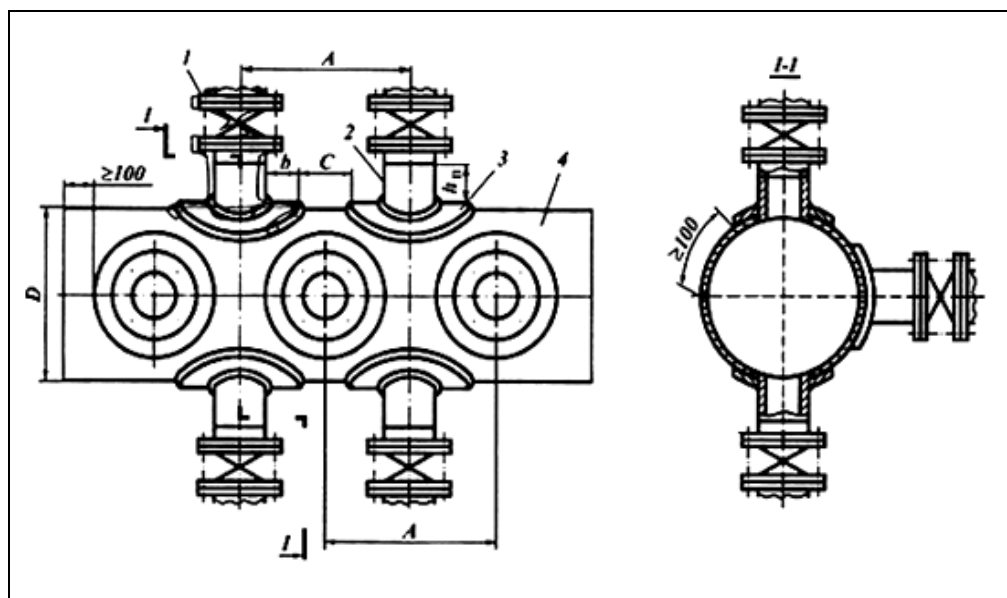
Схема расстановки вантузов при врезке для откачки нефти: 1 - задвижка; 2 - патрубок; 3 - усиливающая накладка (воротник); 4 - ремонтируемый трубопровод; А - расстояние между вантузами; b – ширина усиливающего воротника; d_v – диаметр вантуза (патрубка); D – диаметр трубопровода; h_n – высота патрубка (определяется техническими параметрами применяемого для вырезки приспособления), $h_n \geq 100$ мм; С – минимальное расстояние между усиливающими воротниками
